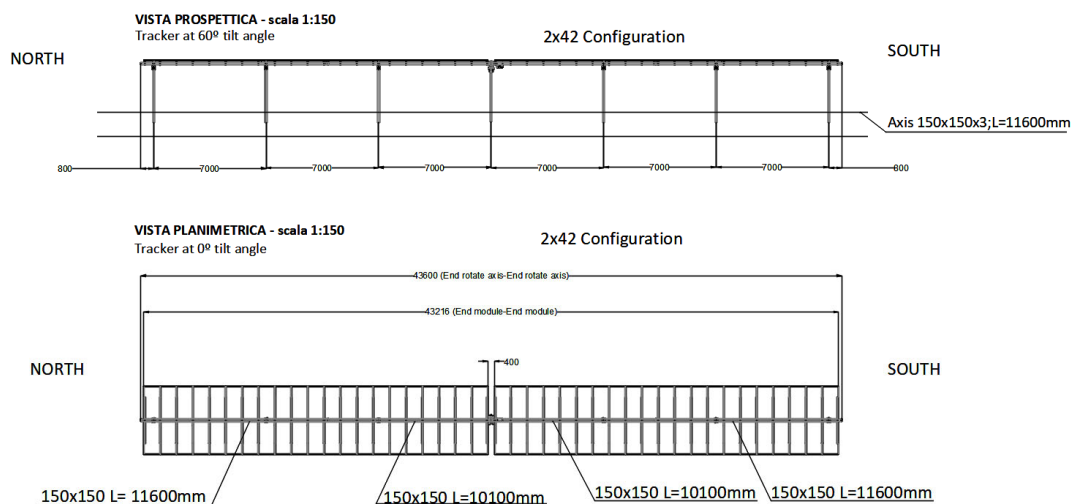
Vista prospettica e planimetrica delle strutture porta-moduli tracker 2x42
